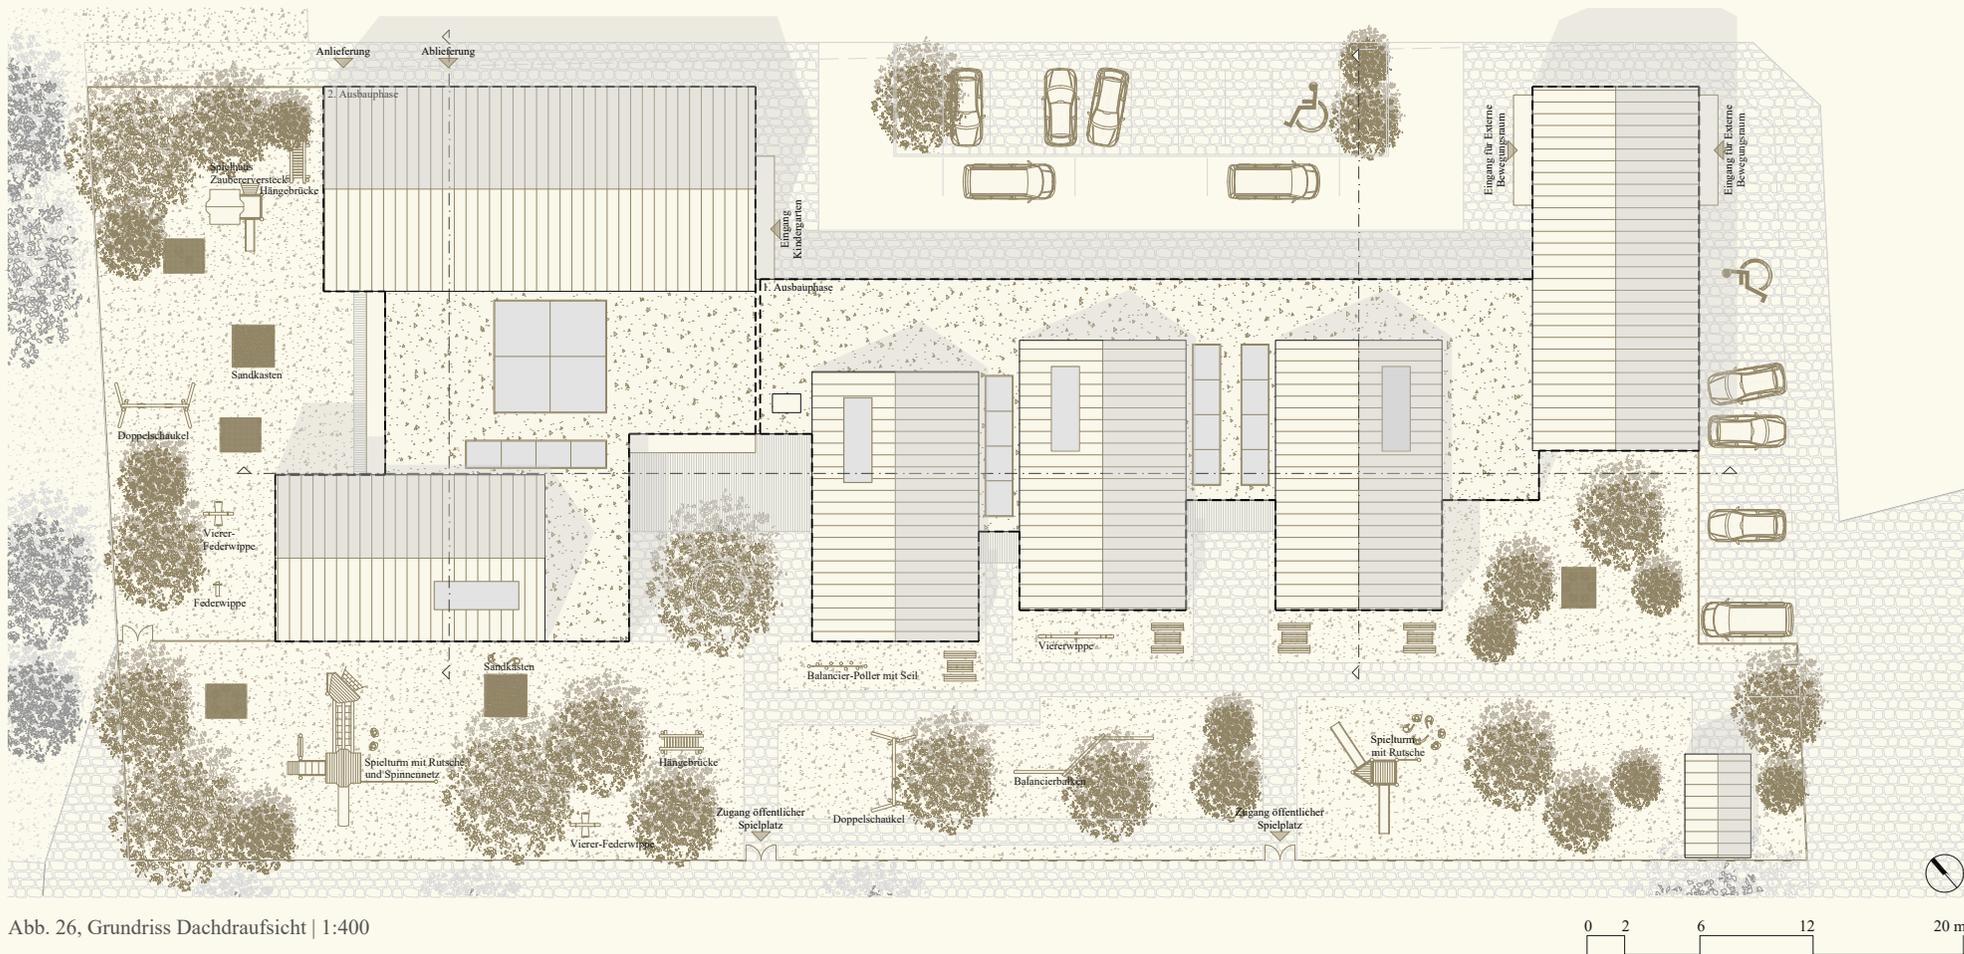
, Grundriss Dachdraufsicht | 1:400
